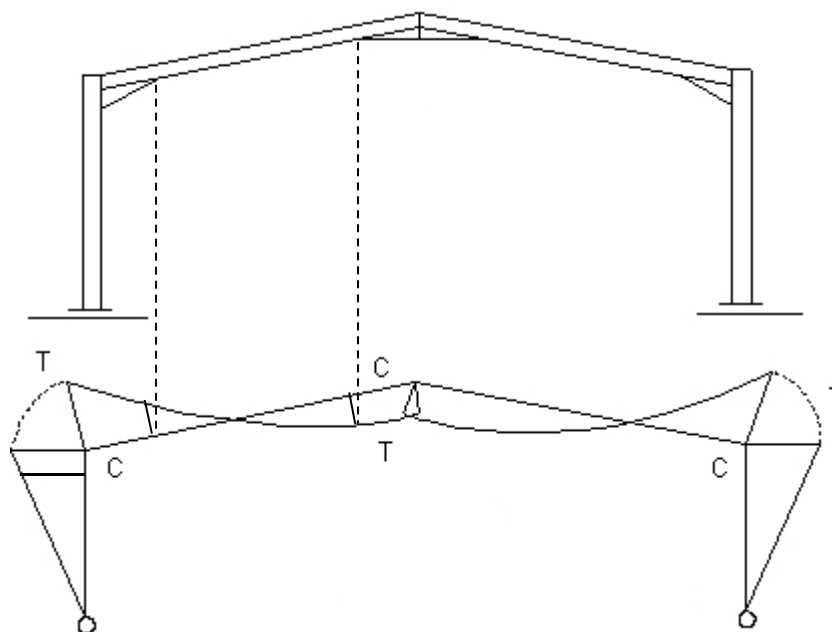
Ligações pilar/travesse e entre travessas – modelo de cálculo
